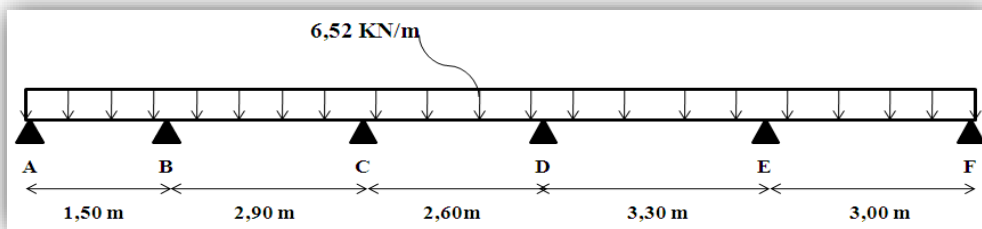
Poutre à cinq travées du plancher terrasse inaccessible.
